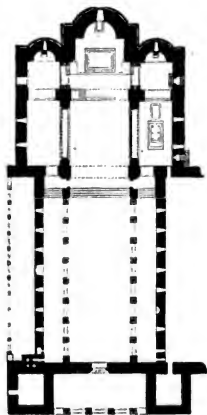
Grundriss der Kirche von Monreale.
